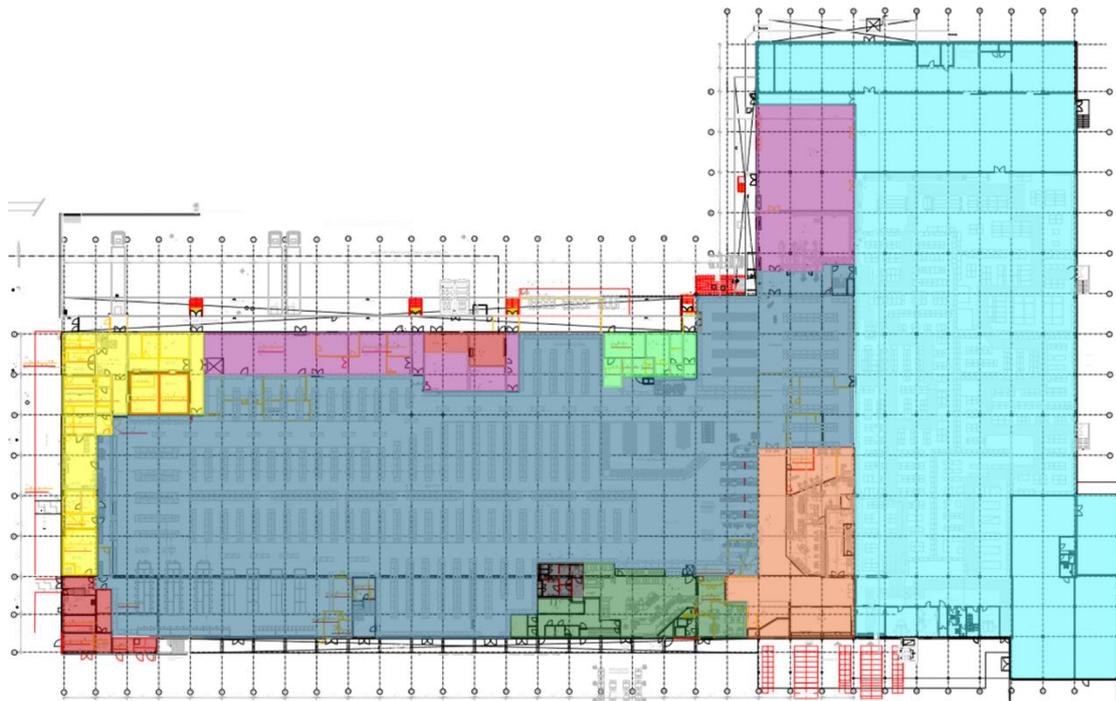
Grundriss Erdgeschoss [2] bearbeitet
